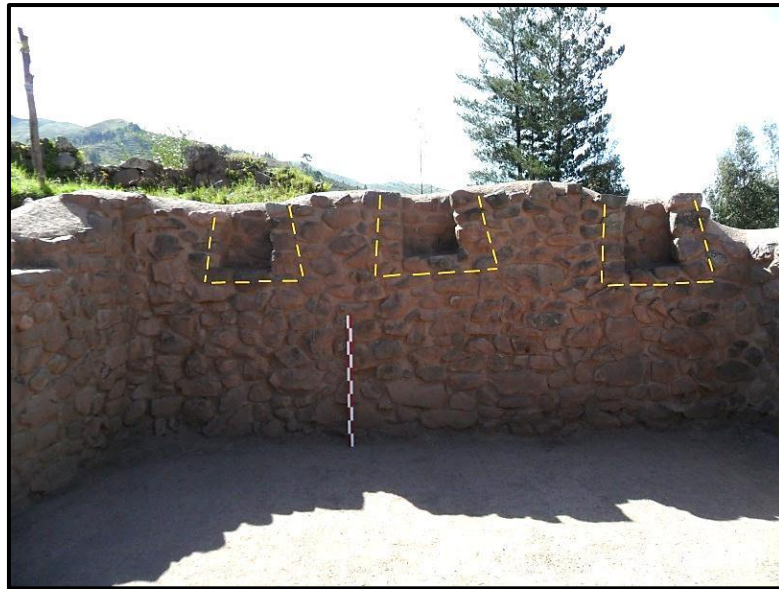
Hornacinas paralelas ubicadas en el muro lateral oeste. (Fuente Propia)
